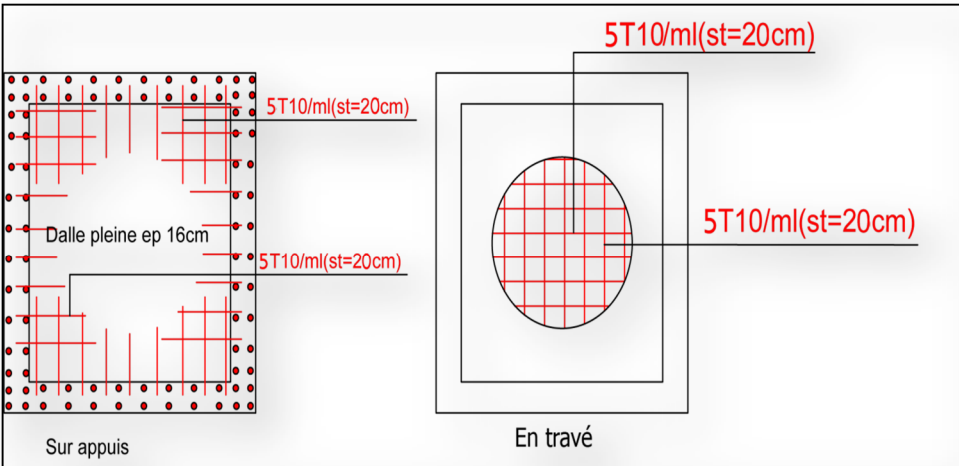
Ferrailage du voile et dalle d'ascenseur
